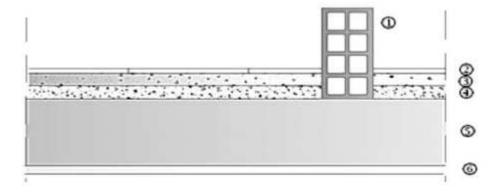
C: coupe verticale d'un plancher en dalle pleine.
